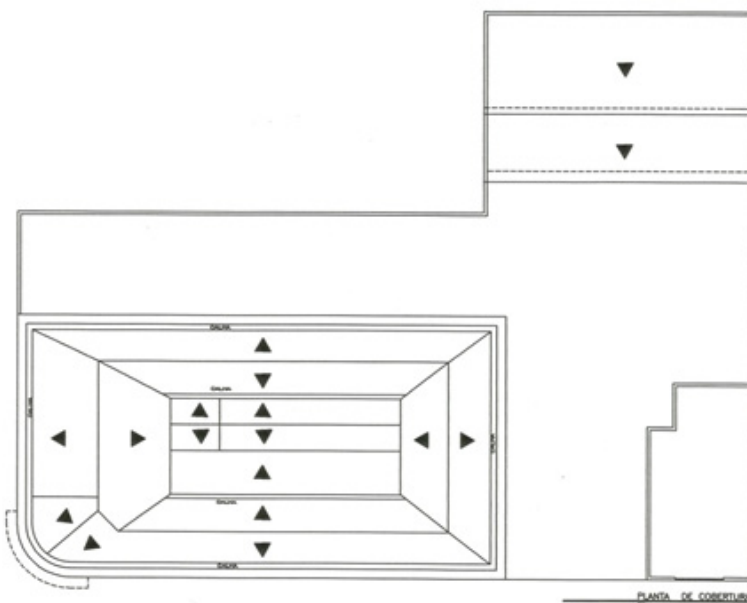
Planta da Cobertura do Palace Hotel de Campinas.
